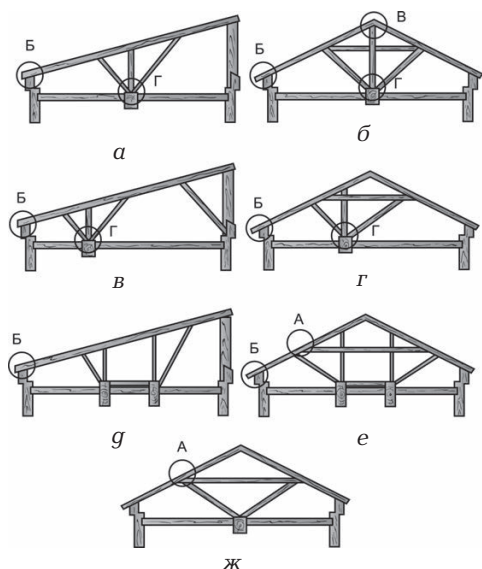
Схемы крыш с системой наслонных стропил: а — для пролета до 12 м; б — для пролета до 10–14 м (без ригеля — до 10 м; с ригелем — до 14 м); в, г — для пролета до 14 м; д, е — для пролета до 16 м; ж — для пролета до 14 м
